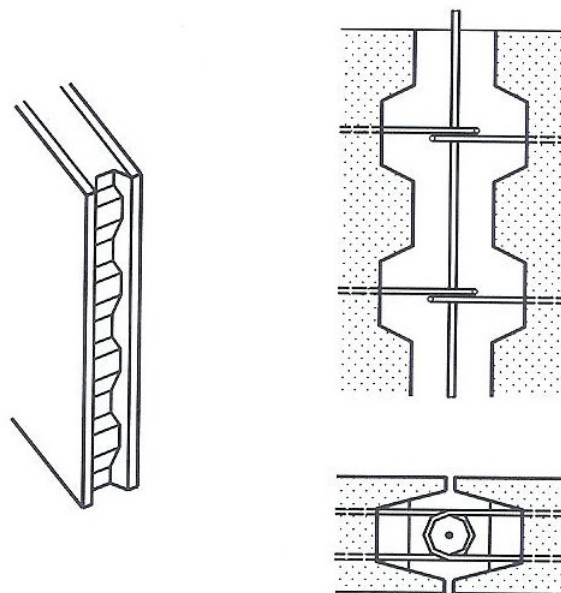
Ligação parede - parede com betonagem da junta vertical [6]
